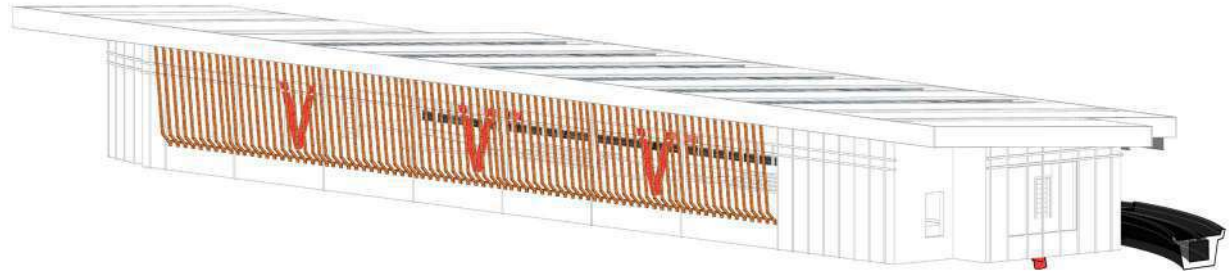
Detalle de estructura de Cubierta – Andén de Telepron
